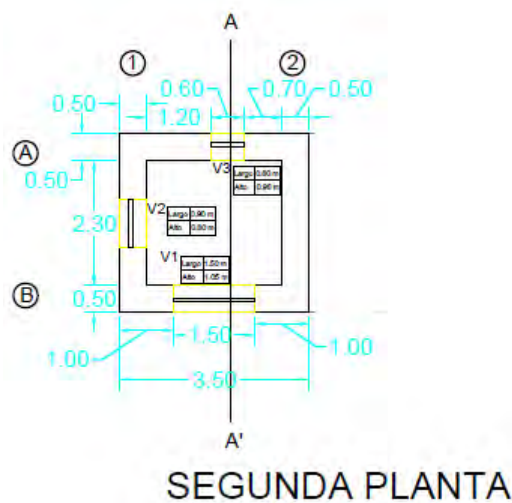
Configuración arquitectónica semi cuadrada, plano en planta de la vivienda encuestada n° 11. Fuente: Fuente: Elaboración propia, 2019.
